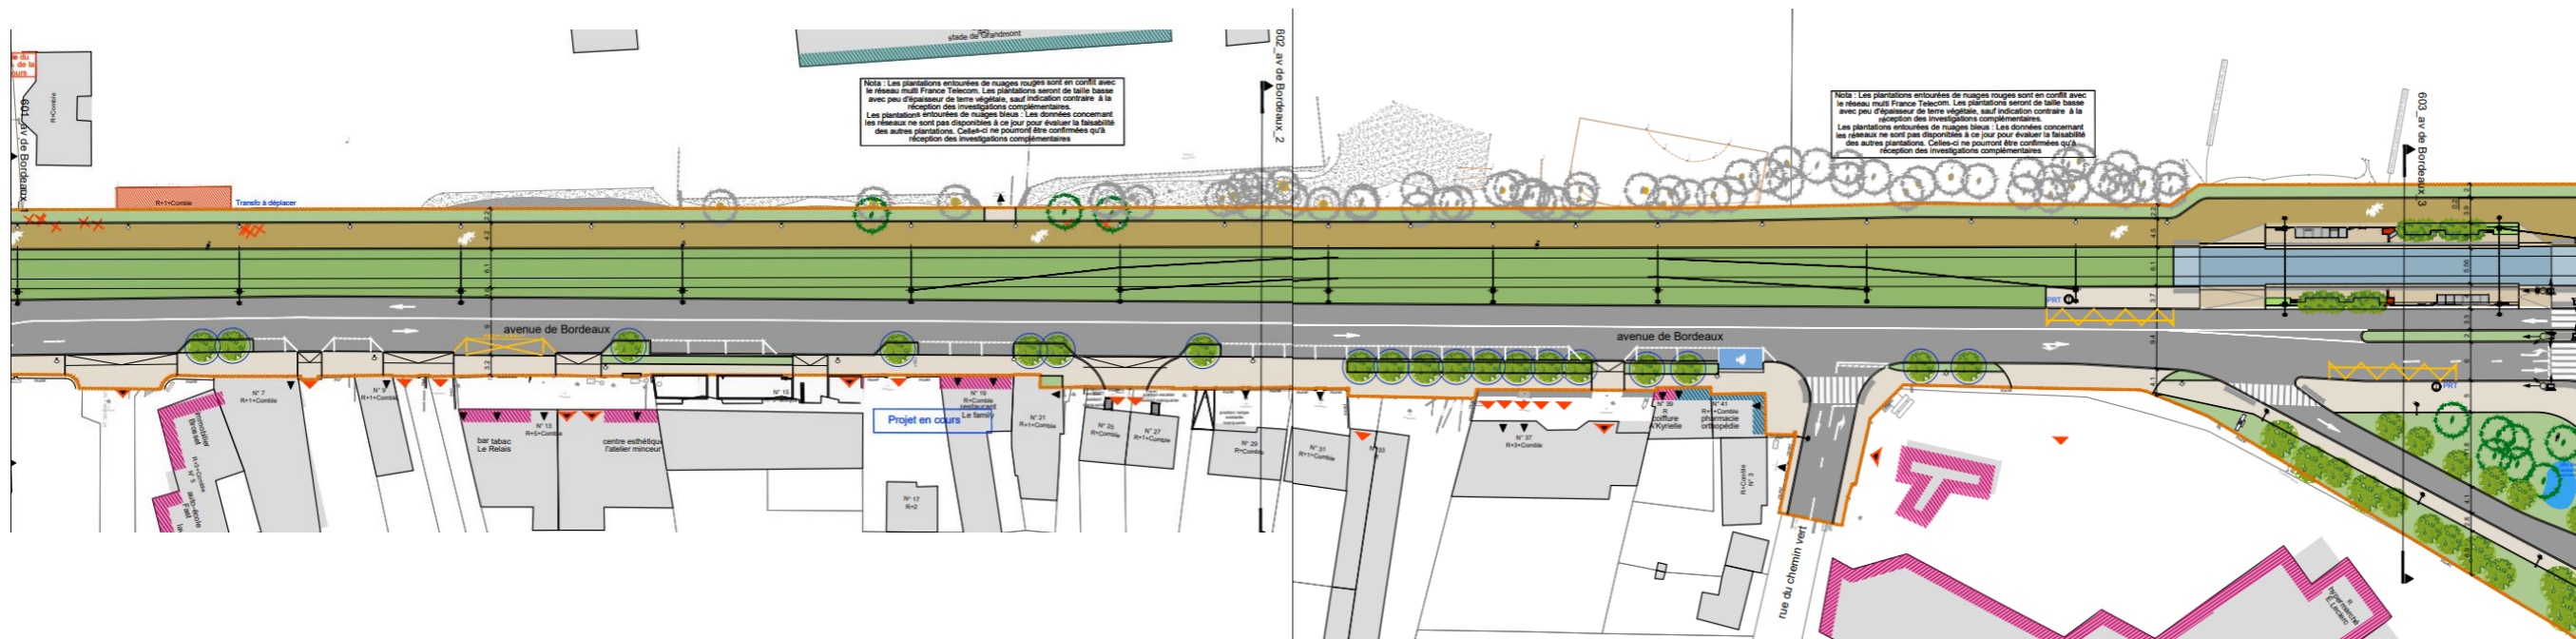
plan d'aménagement sur l'avenue de Bordeaux
